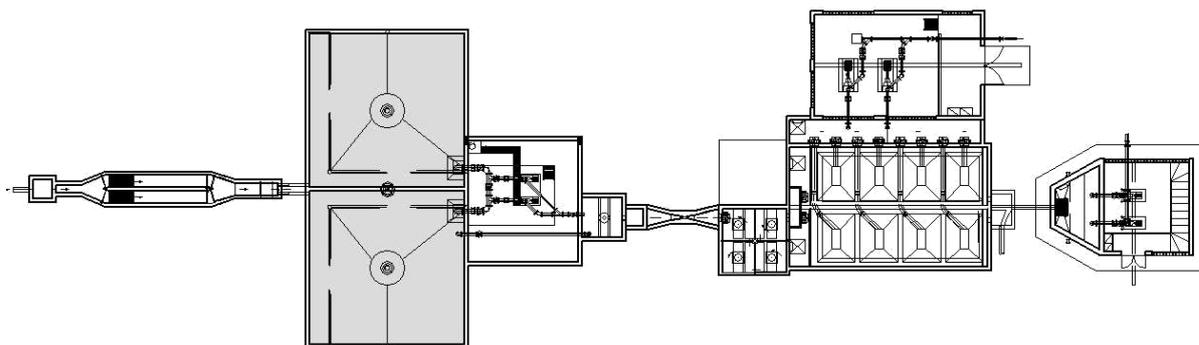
Planta baixa simplificada da ETE da Capricórnio S/A - NATAL.
